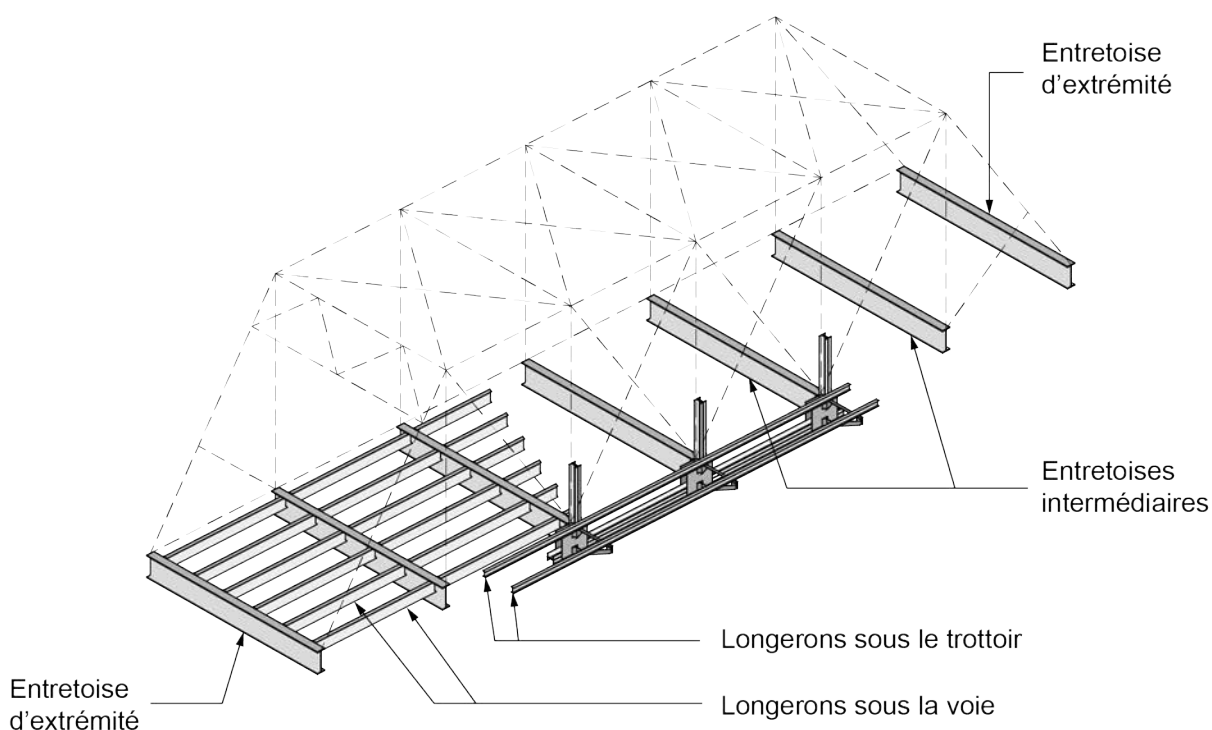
Structure de tablier d'un pont à poutres triangulées
